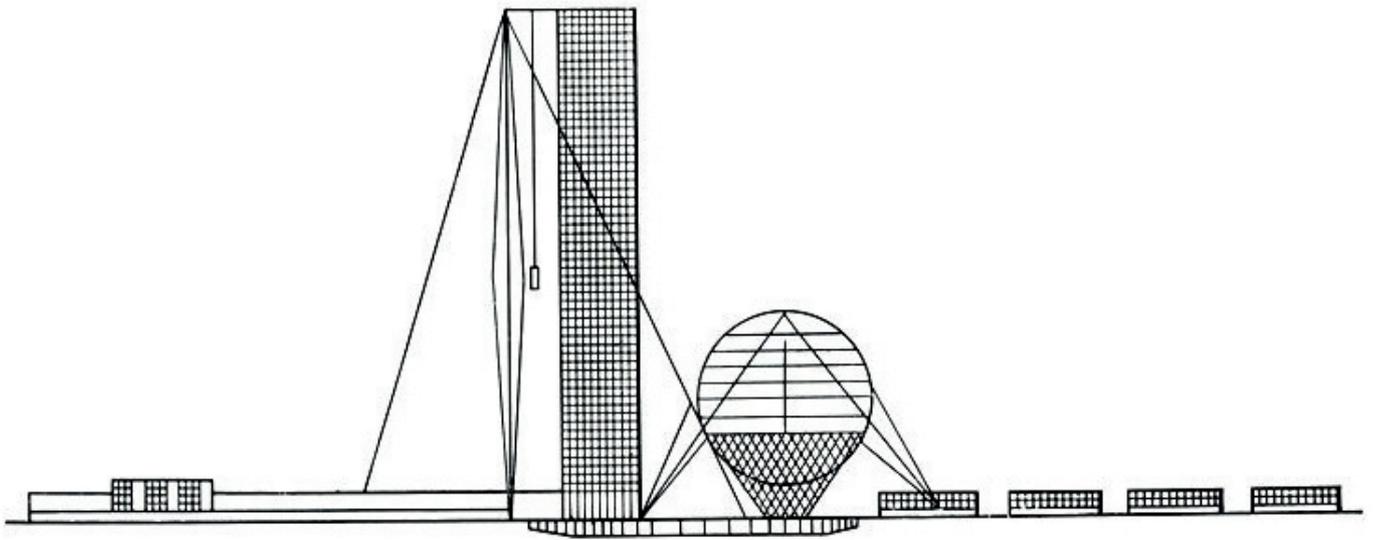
I. Leonidov , Istituto Lenin, Prospetto
